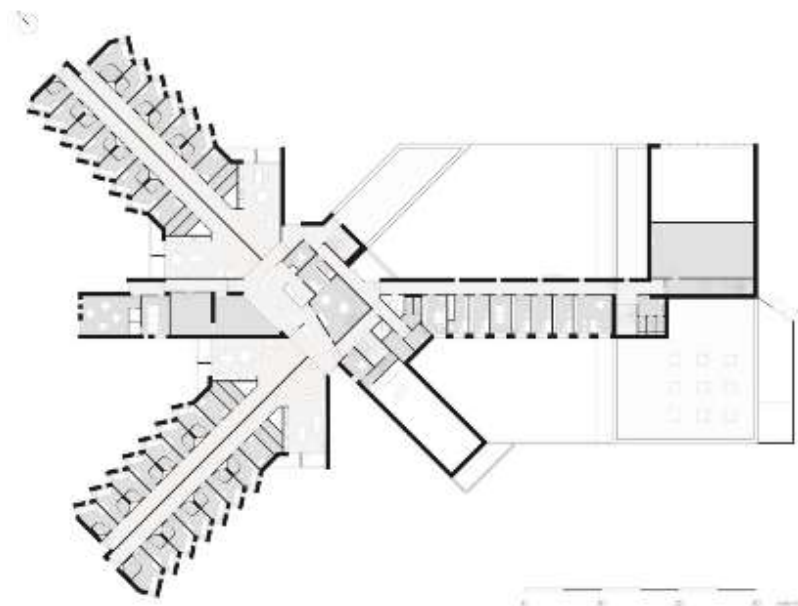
Storstrom Prison – Planta Baixa da cela.
